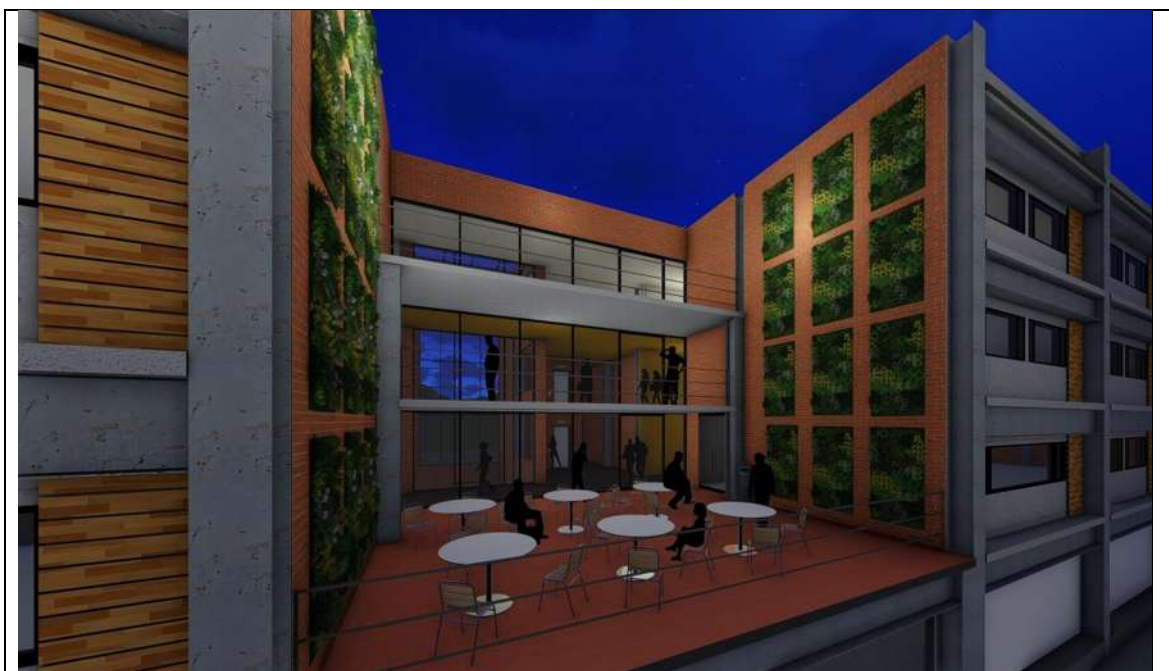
Render de muros verdes en el proyecto. Fuente: autor
